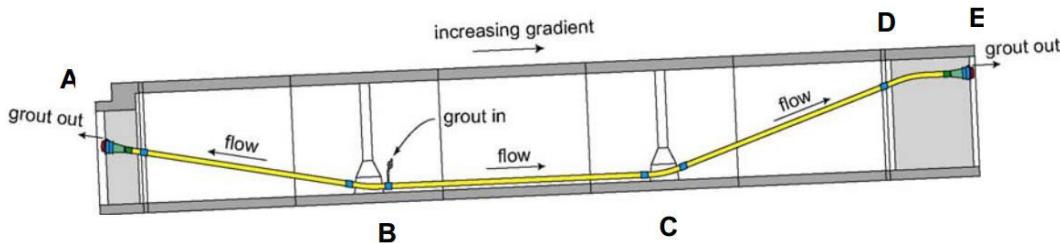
Detalles de grouting para el tendon exterior del tramo exterior.
